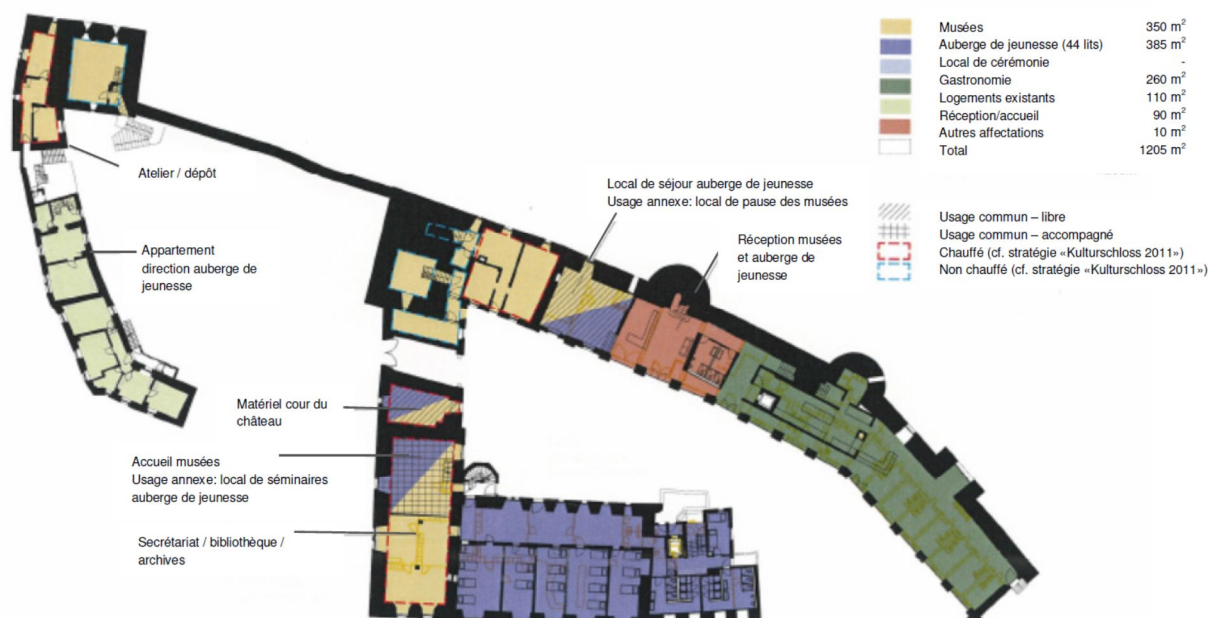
utilisation prévue de la superficie du château – rez-de-chaussée
